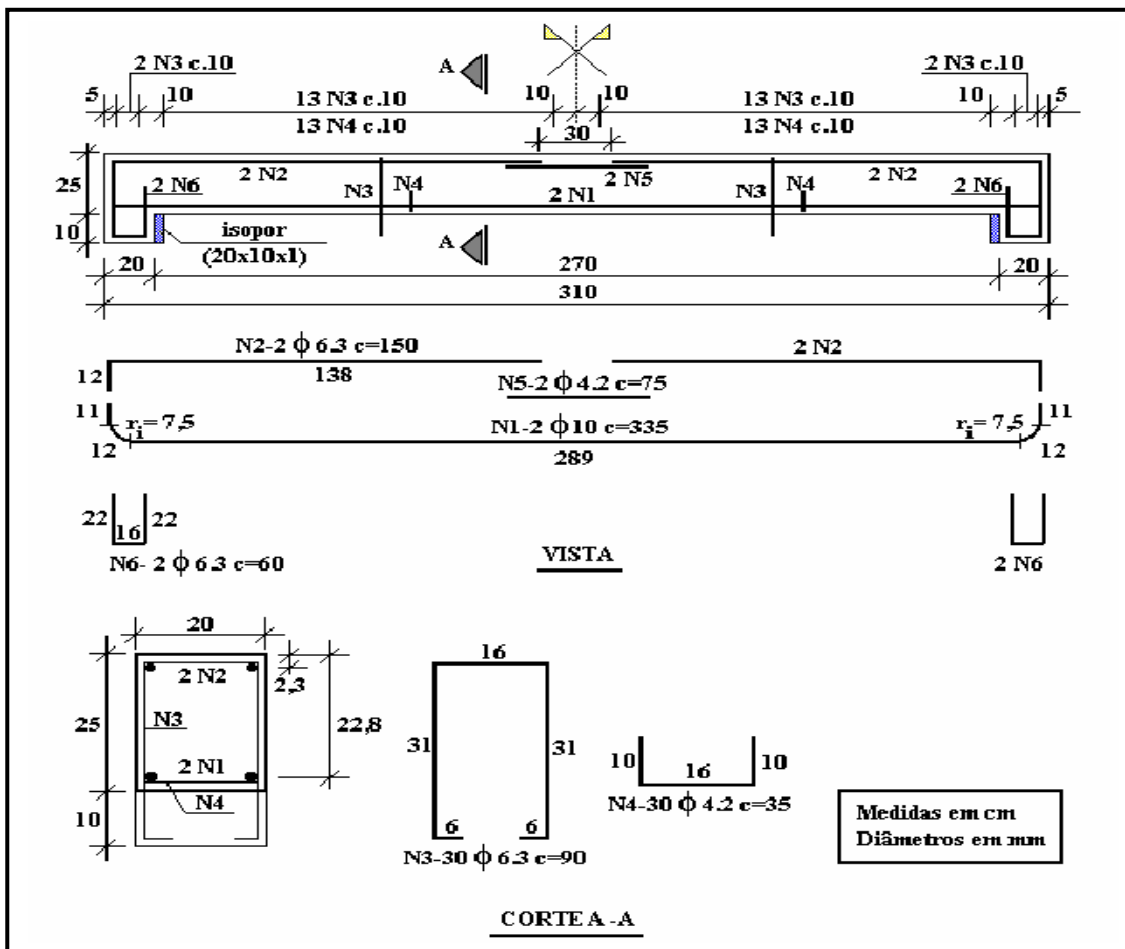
Detalhamento das vigas originais (PIANCASTELI e CALIXTO, 2002).
